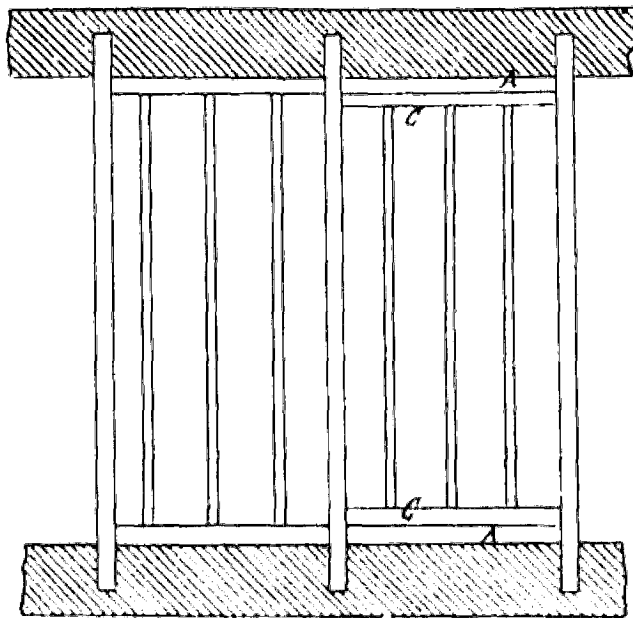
Disposition d'un plancher avec chevêtres et faux-chevêtres.
